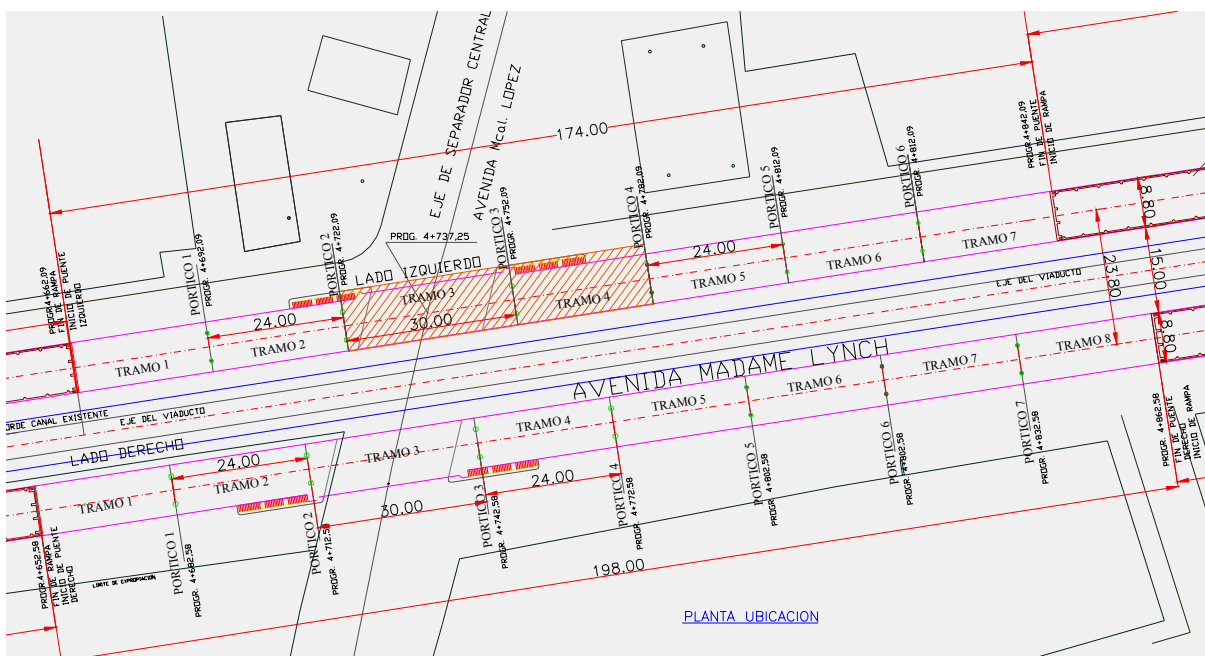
PLANTA DEL VIADUCTO IN SITU, CON LOS TRAMOS CAPACES DE SER CONSTRUÍDOS POR VEZ (LONGITUD = 62 m.) PARA LA COMPARACIÓN 1.
